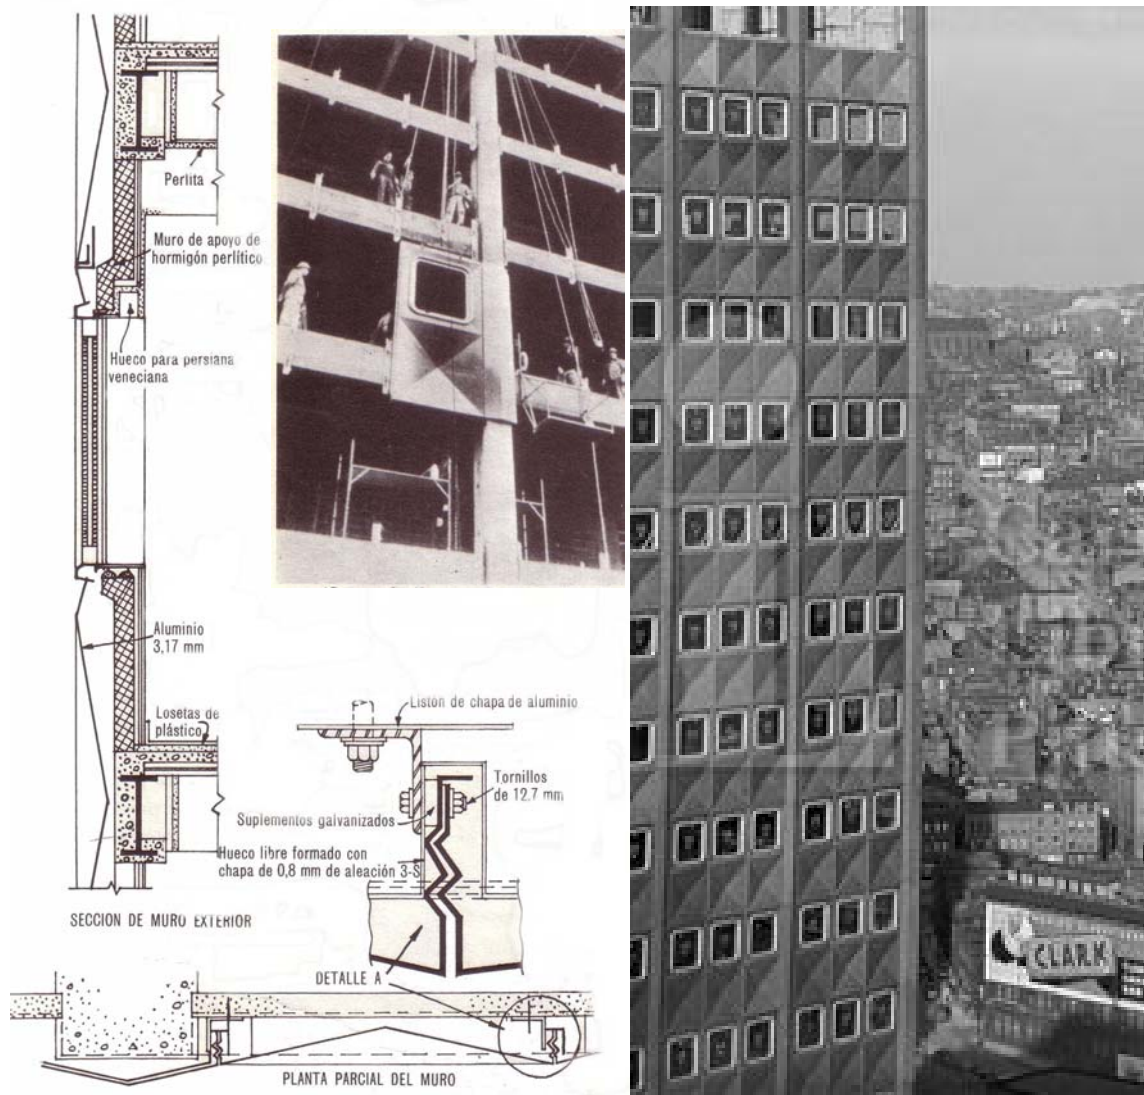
Detalles constructivos de la fachada, foto de montaje y aspecto general del edificio para la Sede de ALCOA
